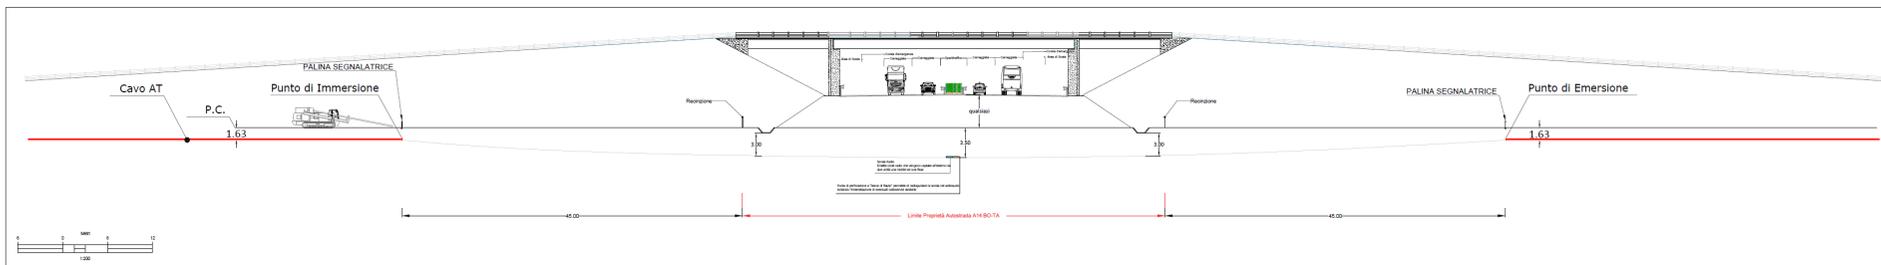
Tipico Attraversamento in T.O.C. rete Autostradale
